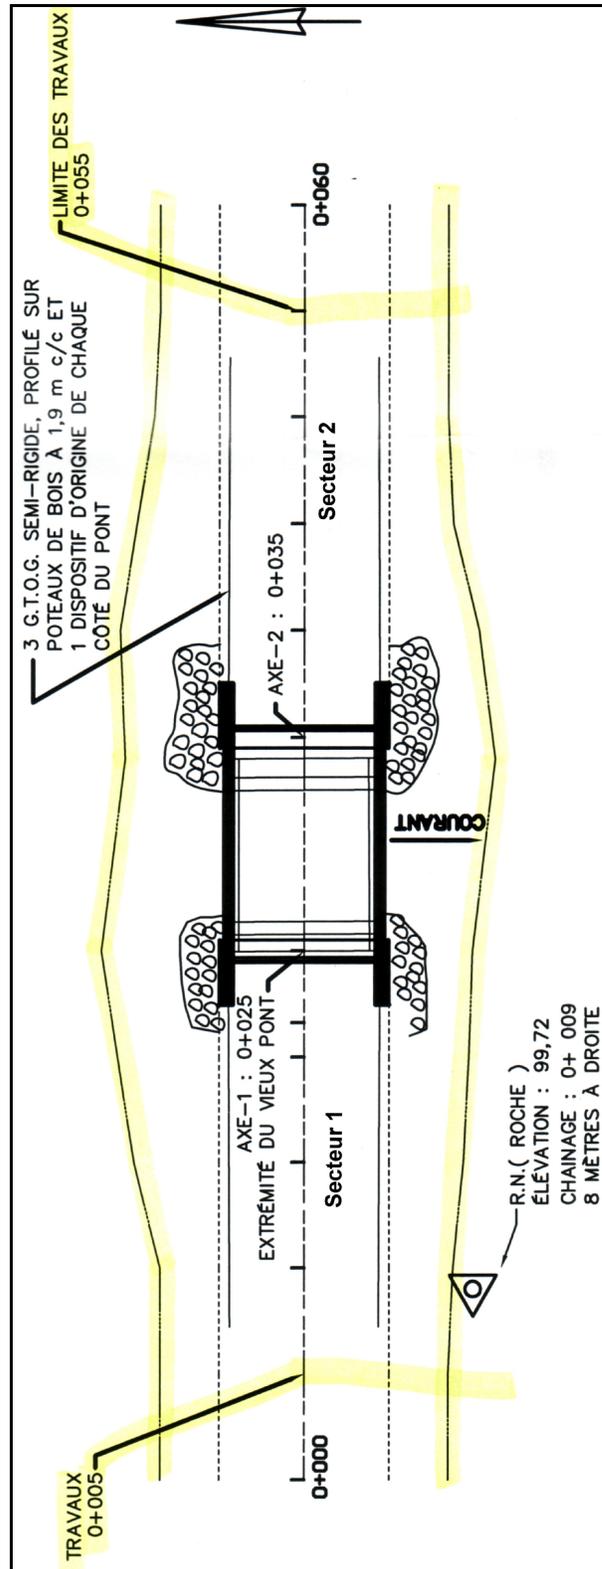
Localisation des secteurs d'inventaire sur le plan de construction du projet 20-6671-9340, rang Bisson
